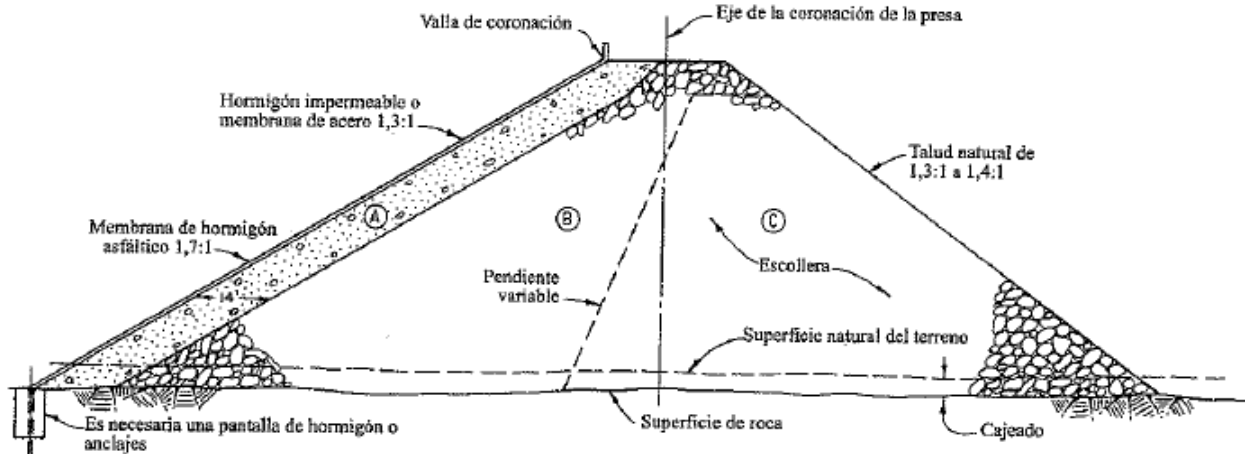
Zonas materiales de presas de escollera; Fuente: Diseño de presas pequeñas.
